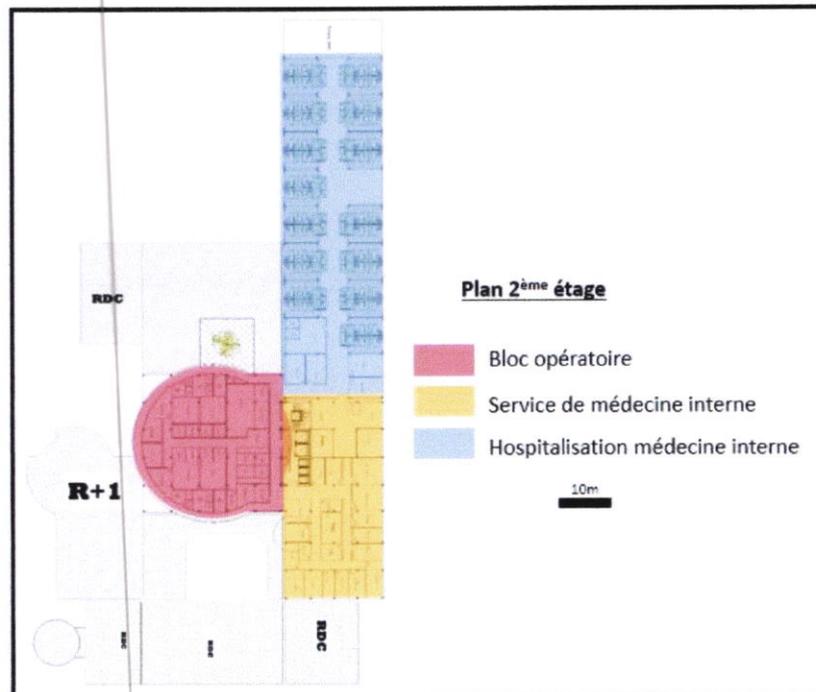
Plan 2<sup>ème</sup> étage-Agencement des unités fonctionnelles Source : Auteurs
